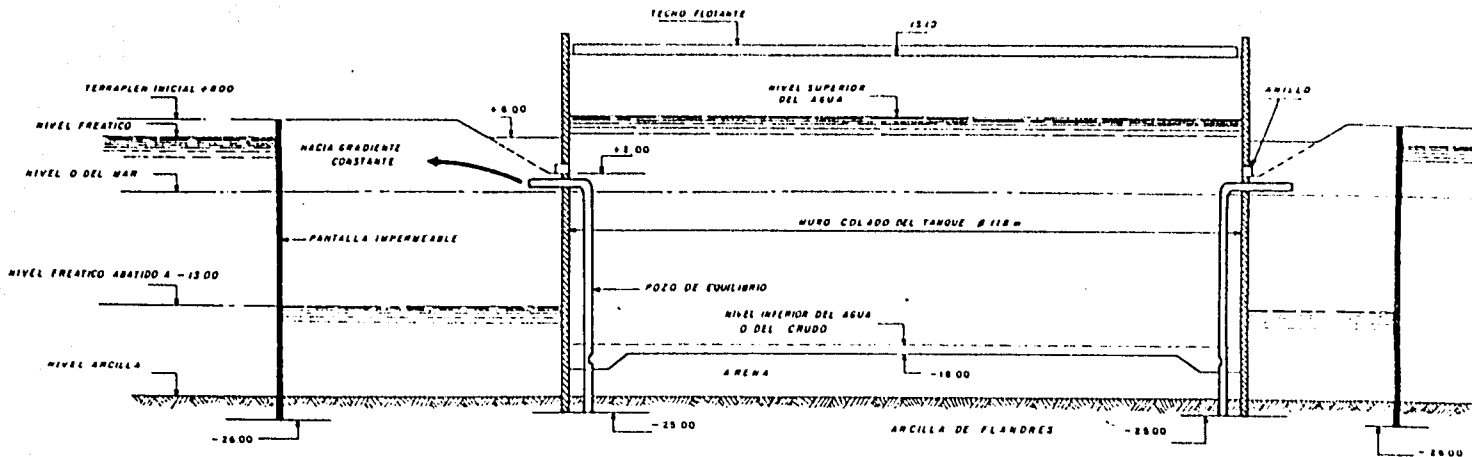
TANQUE PARA ALMACENAMIENTO DE CRUDO TIPO SEMIENTERRADO
